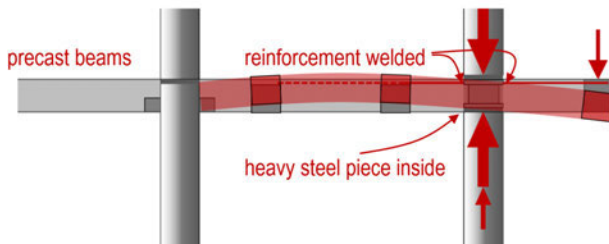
Fertigteilträger mit Auskrägung und Einbauteil zur Durchleitung der Stützenlast
